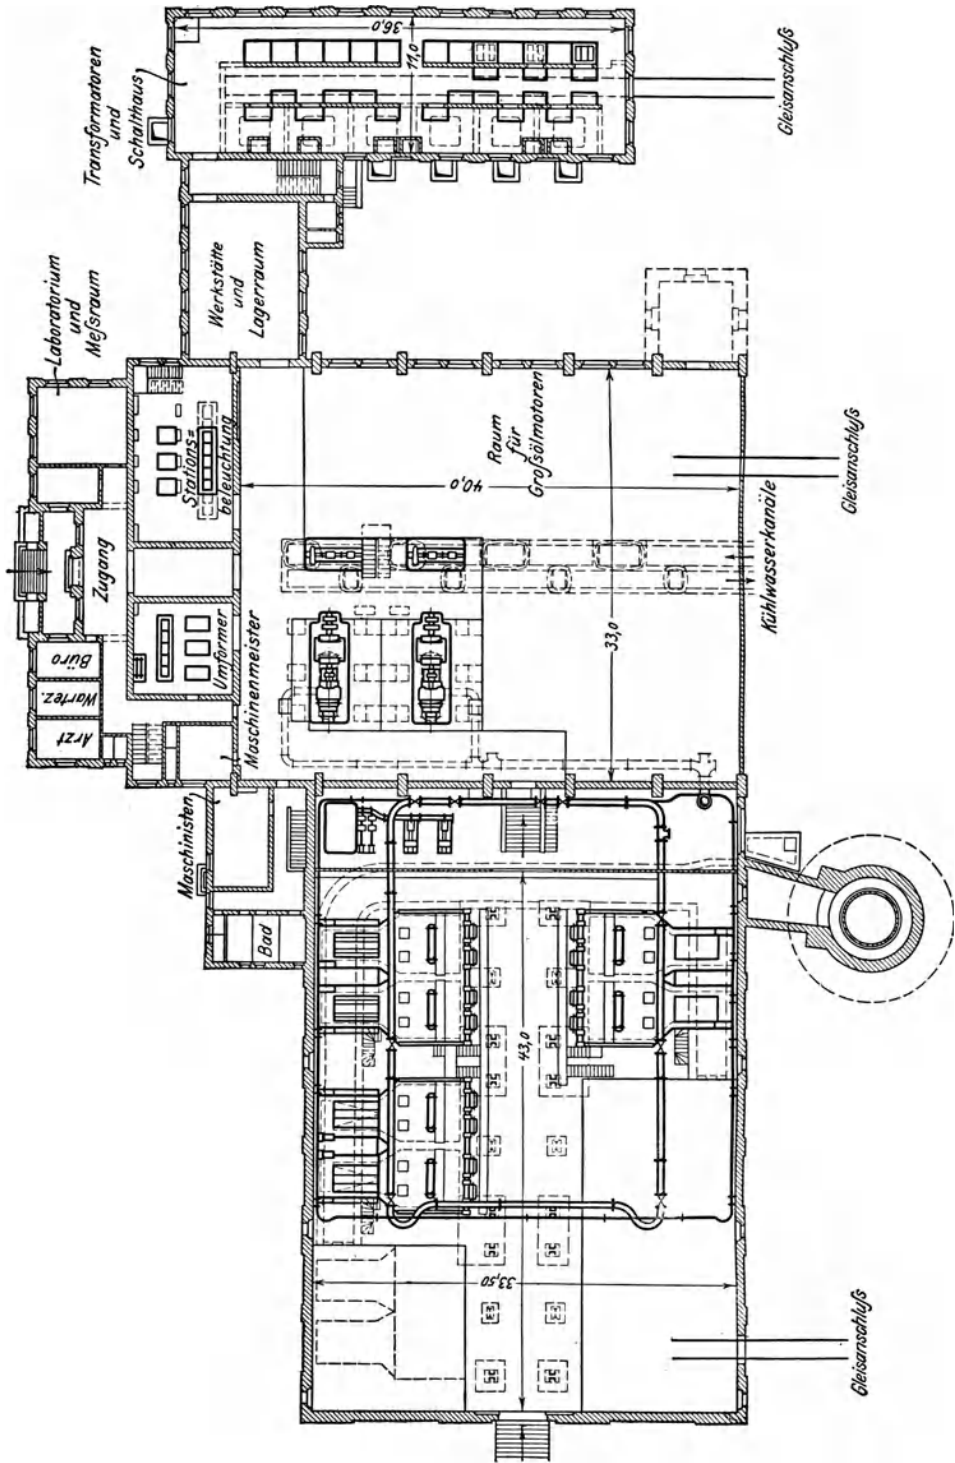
Grundriß des Großkraftwerkes Franken (Maßstab 1 : 600).
